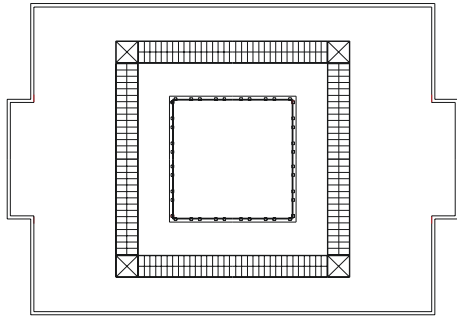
Plan de la toiture du Museo de Arte à Lima
